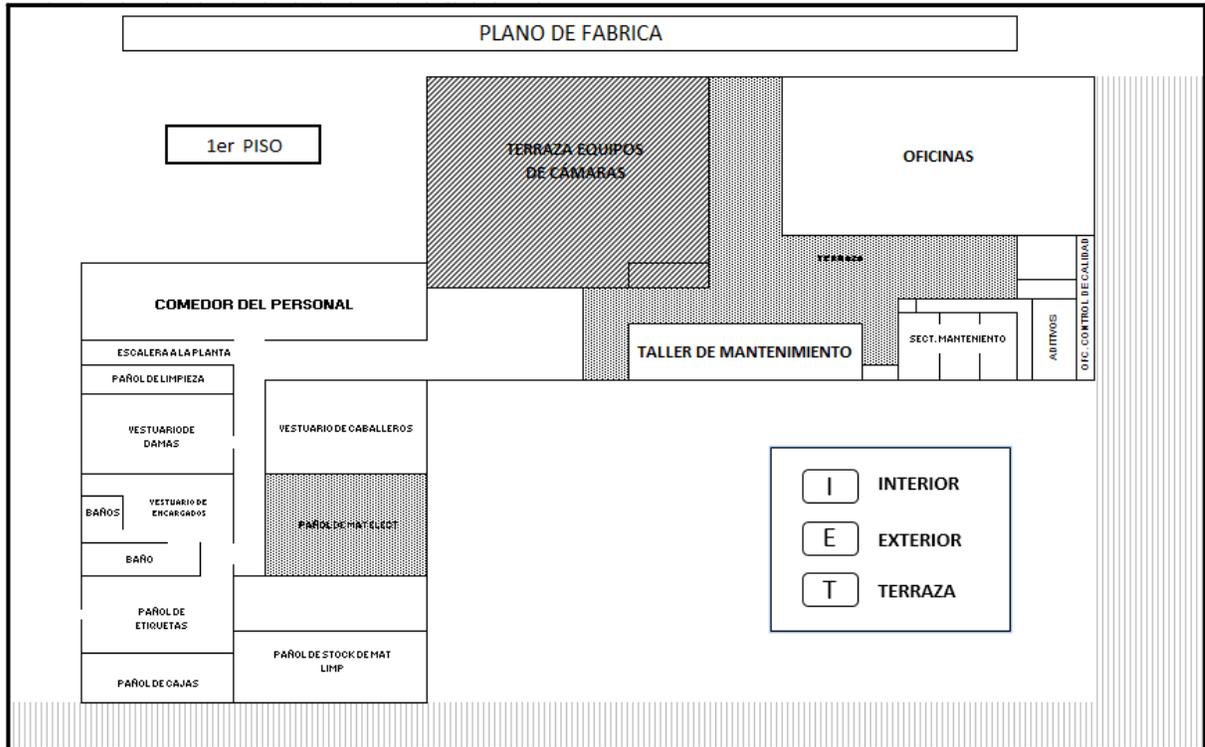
Plano de la planta baja del establecimiento (zona interna y externa).
